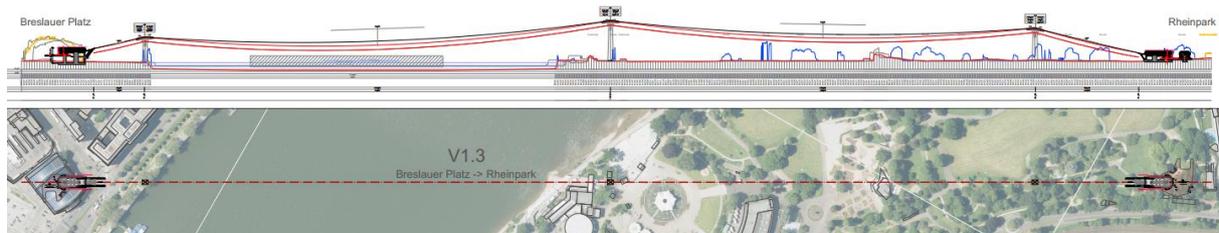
Längenschnitt, Lageplan Variante V1.3
